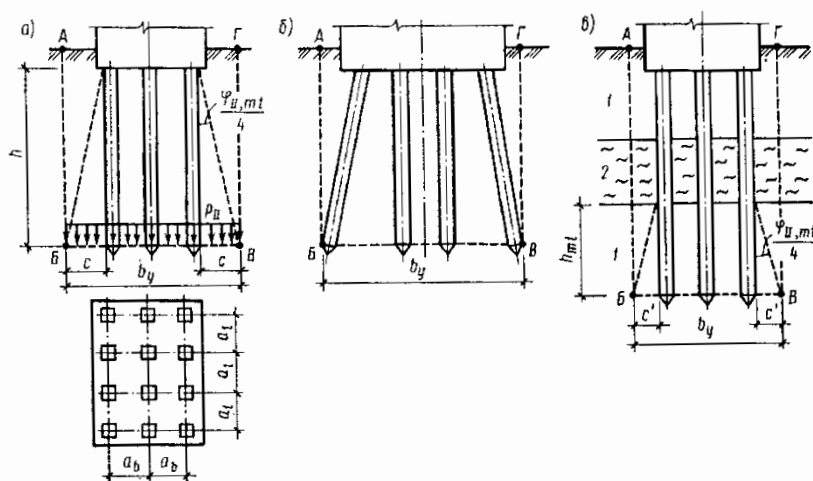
Схемы условных фундаментов для расчета по второй группе предельных состояний
